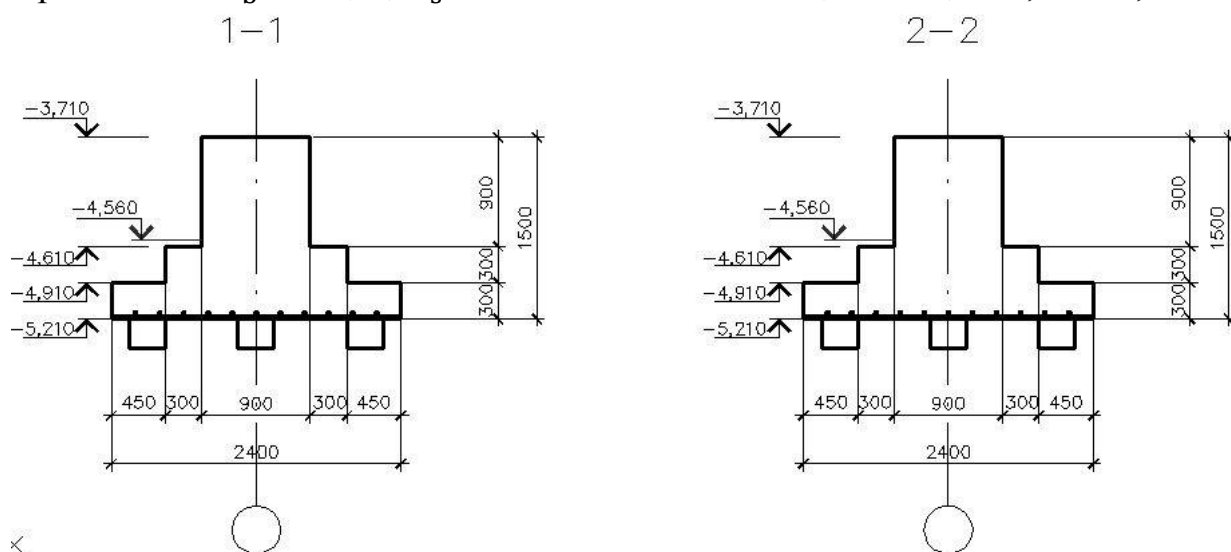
Схема армирования плитной части фундамента
